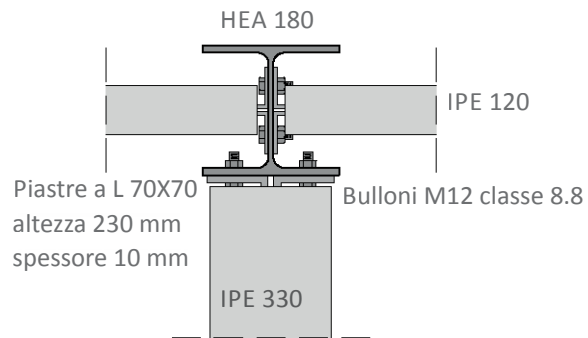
Giunto trave pilastro con la disposizione dei bulloni ipotizzata, sezione orizzontale
